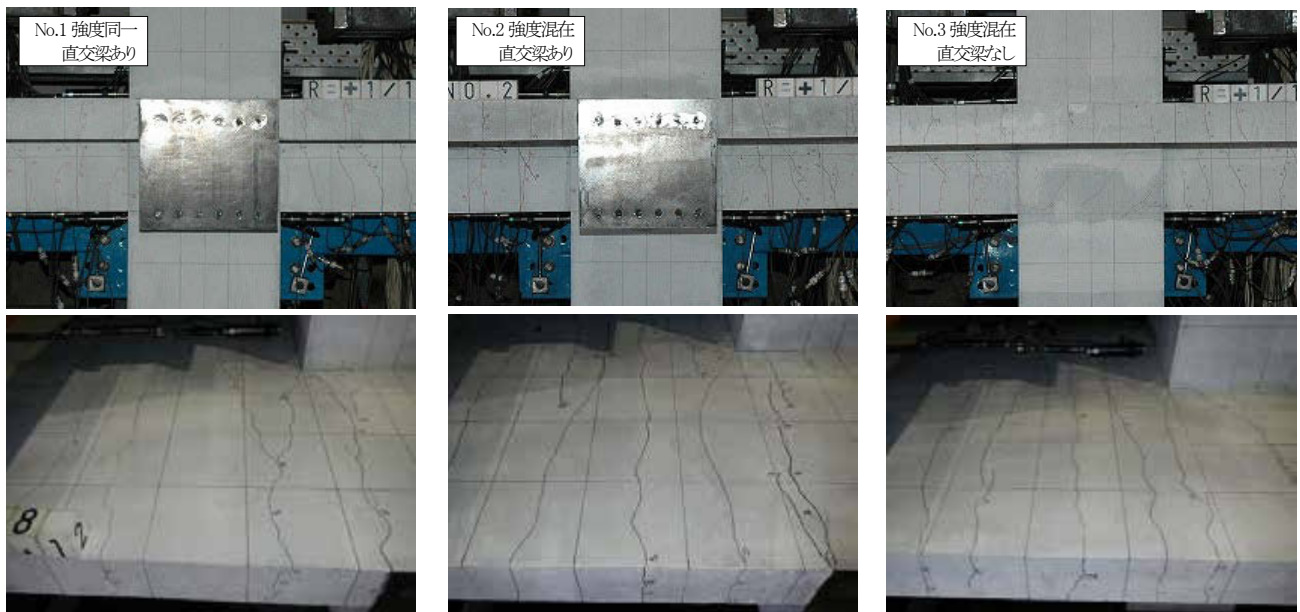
ひび割れ状況($R=+1.0\%$ ピーク時)
